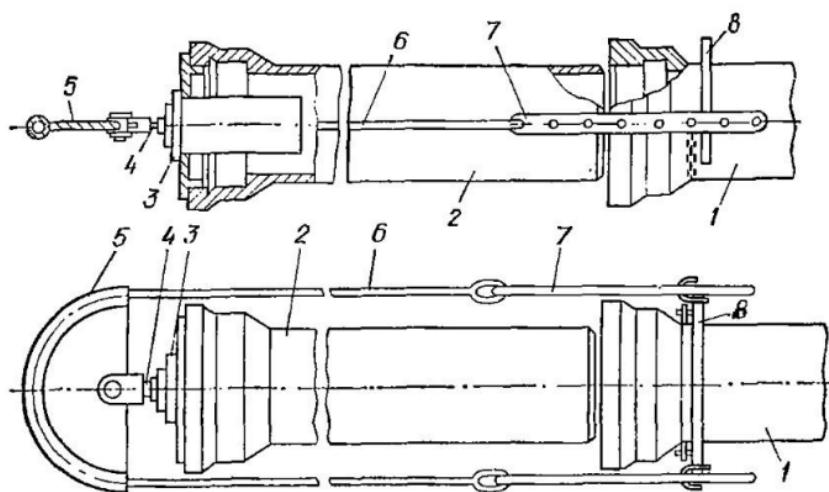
Монтажное приспособление с гибкими тягами и гидроцилиндром
